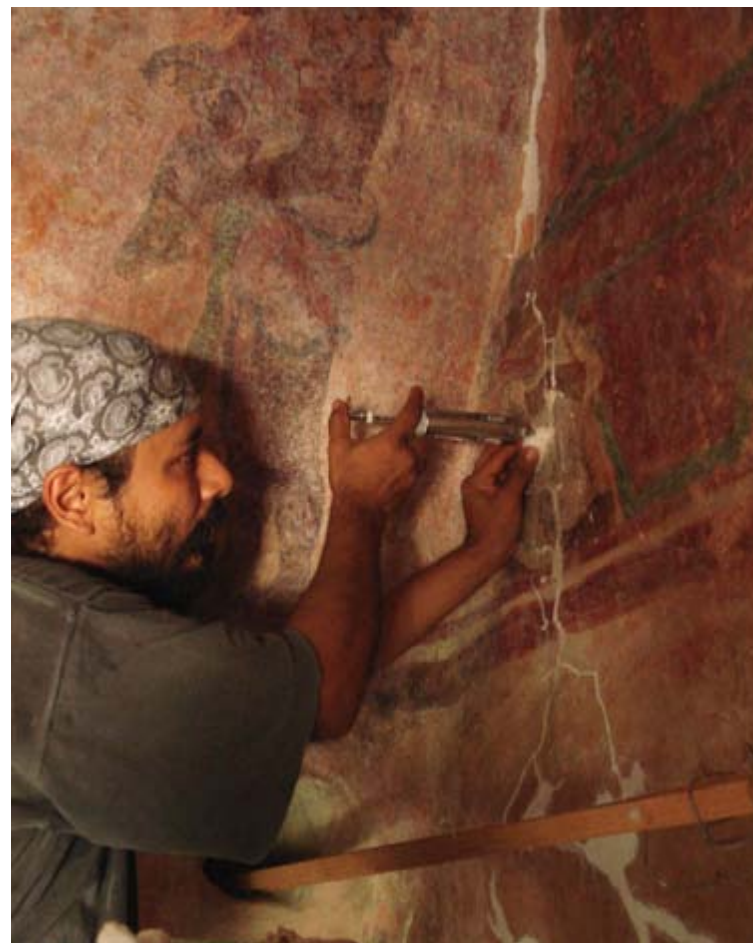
Tratamiento de consolidación en las grietas de los muros. (Fotografía: Haydeé Orea, 2009.)
